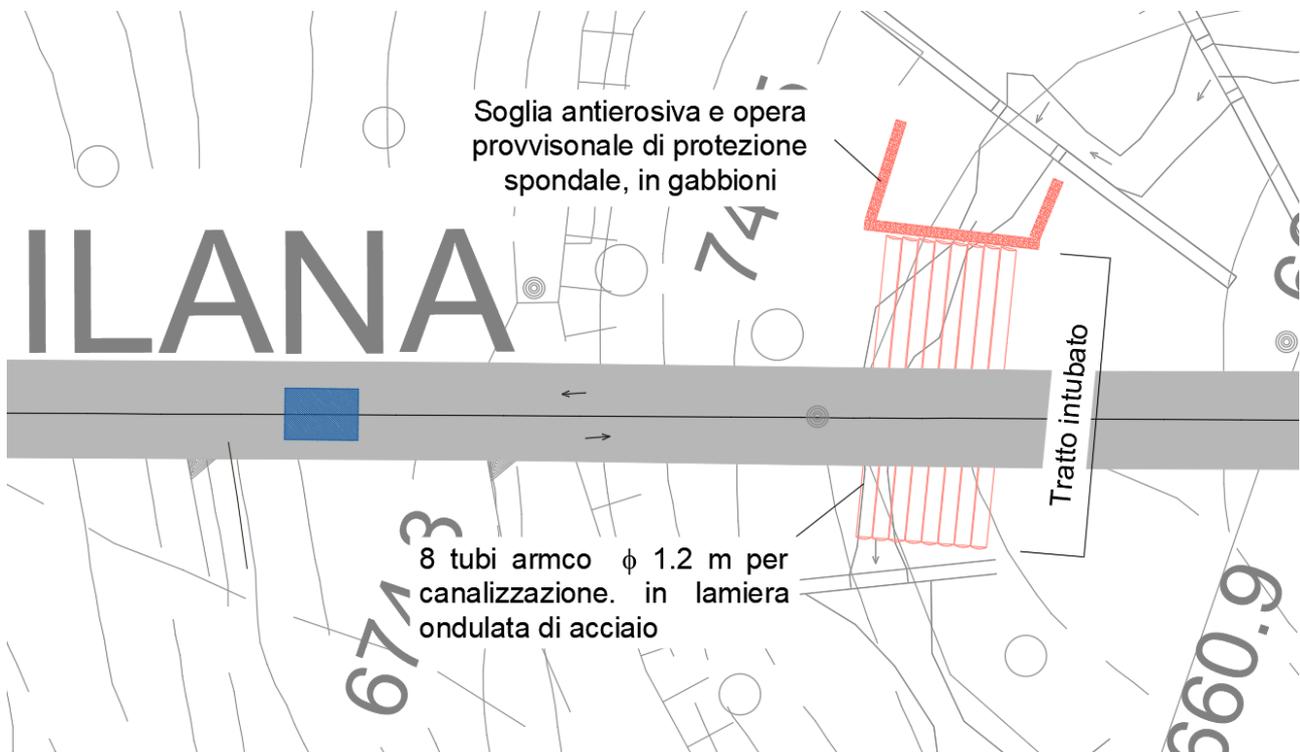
Estratto elaborato V382022002APA "Tavola della fasizzazione dell'intervento di demolizione (1 di 5)"
